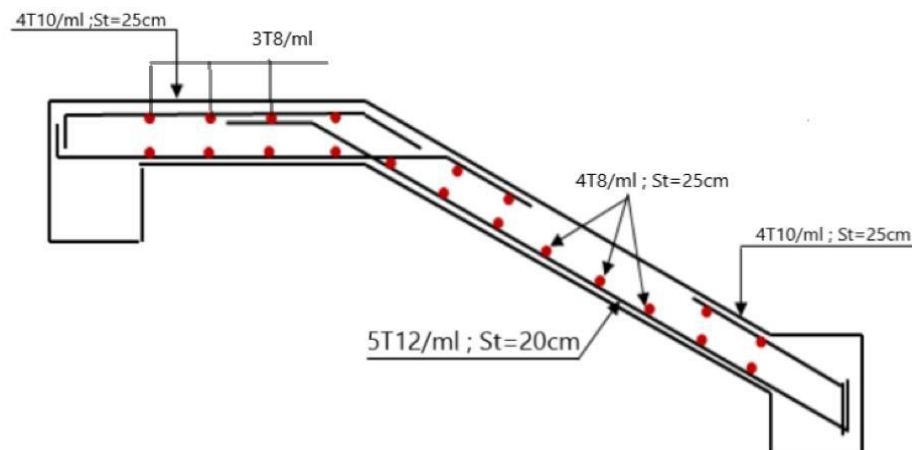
Schéma de ferrailage de l'escalierIII.4 BalconIII.4.1 Définition
